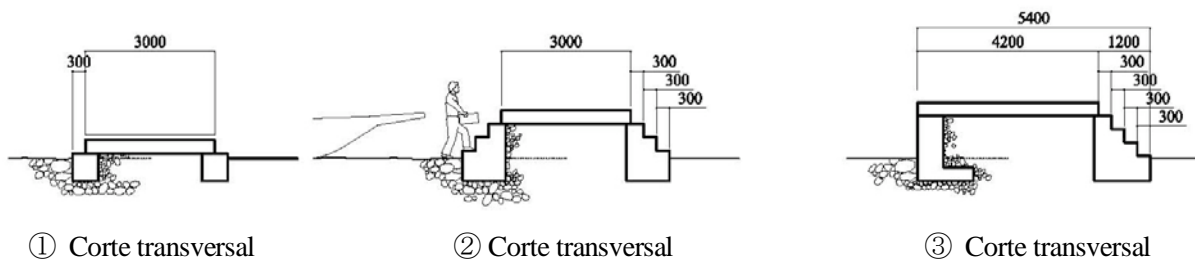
Plano de Corte Transversal da Via de Acesso
